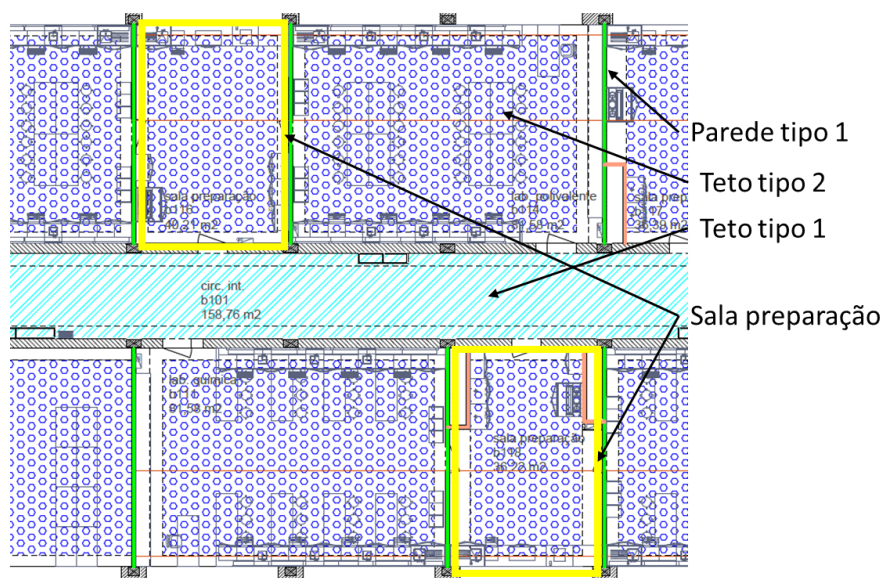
Planta genérica de projeto de acústica para o edifício B [53].
